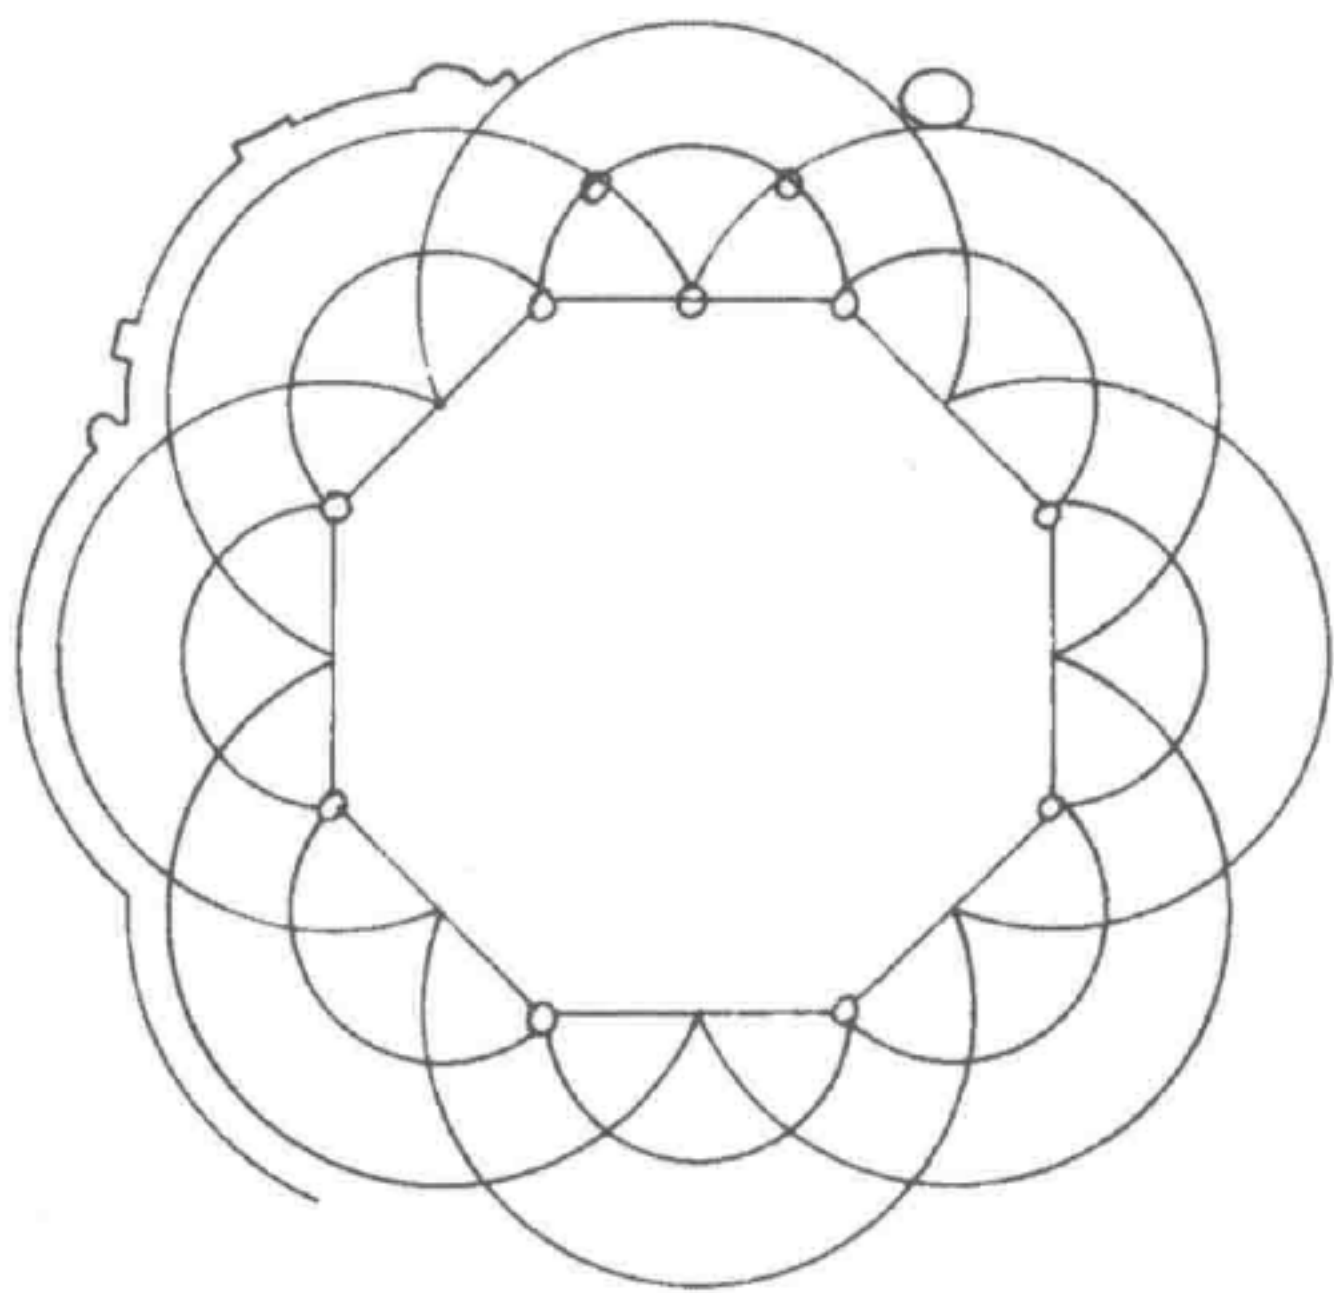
《一座中心对称教堂的平面图》[ *Ground Plan of a Centralized Church* ],
